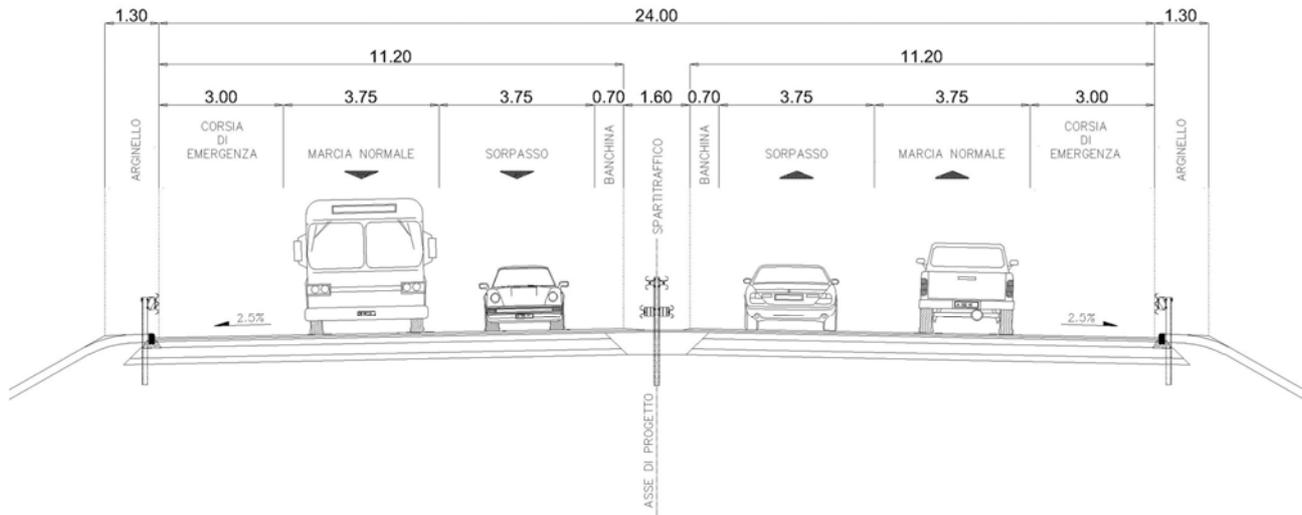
Sezione tipo di progetto nel Tronco Sud (adeguamento SS1 Aurelia)
